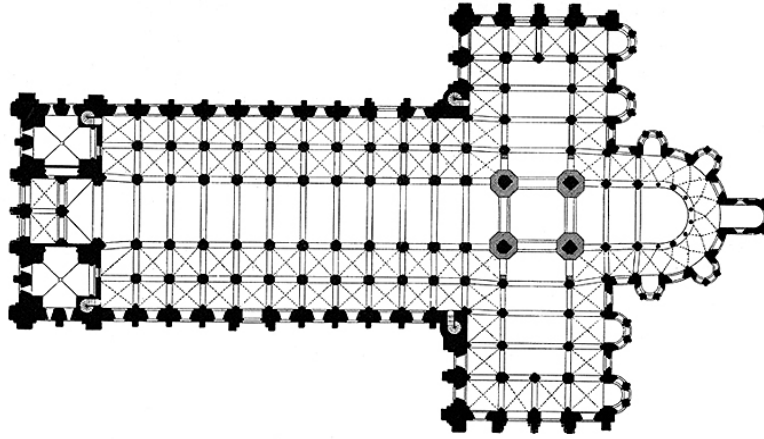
Planta Igreja Saint Sernin em Toulouse, 1120.
